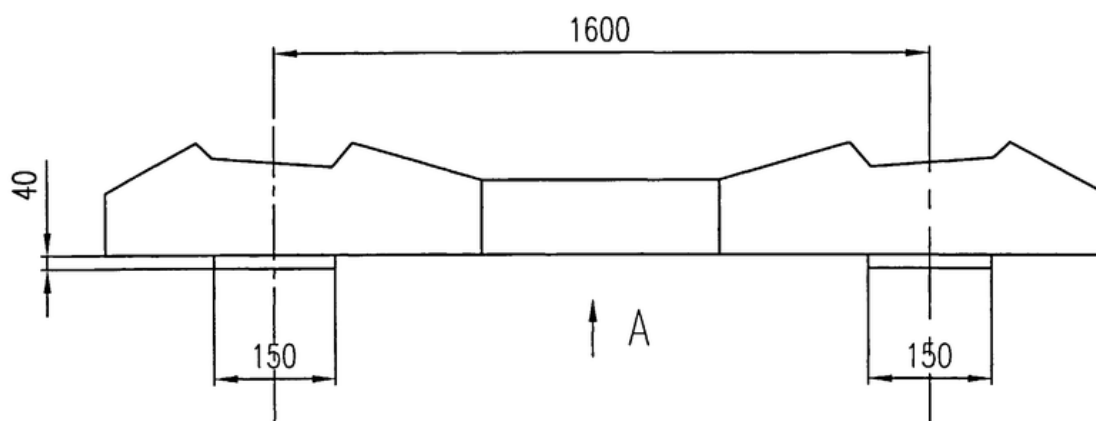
Конструкція рейкової опори із зубатими виступами
